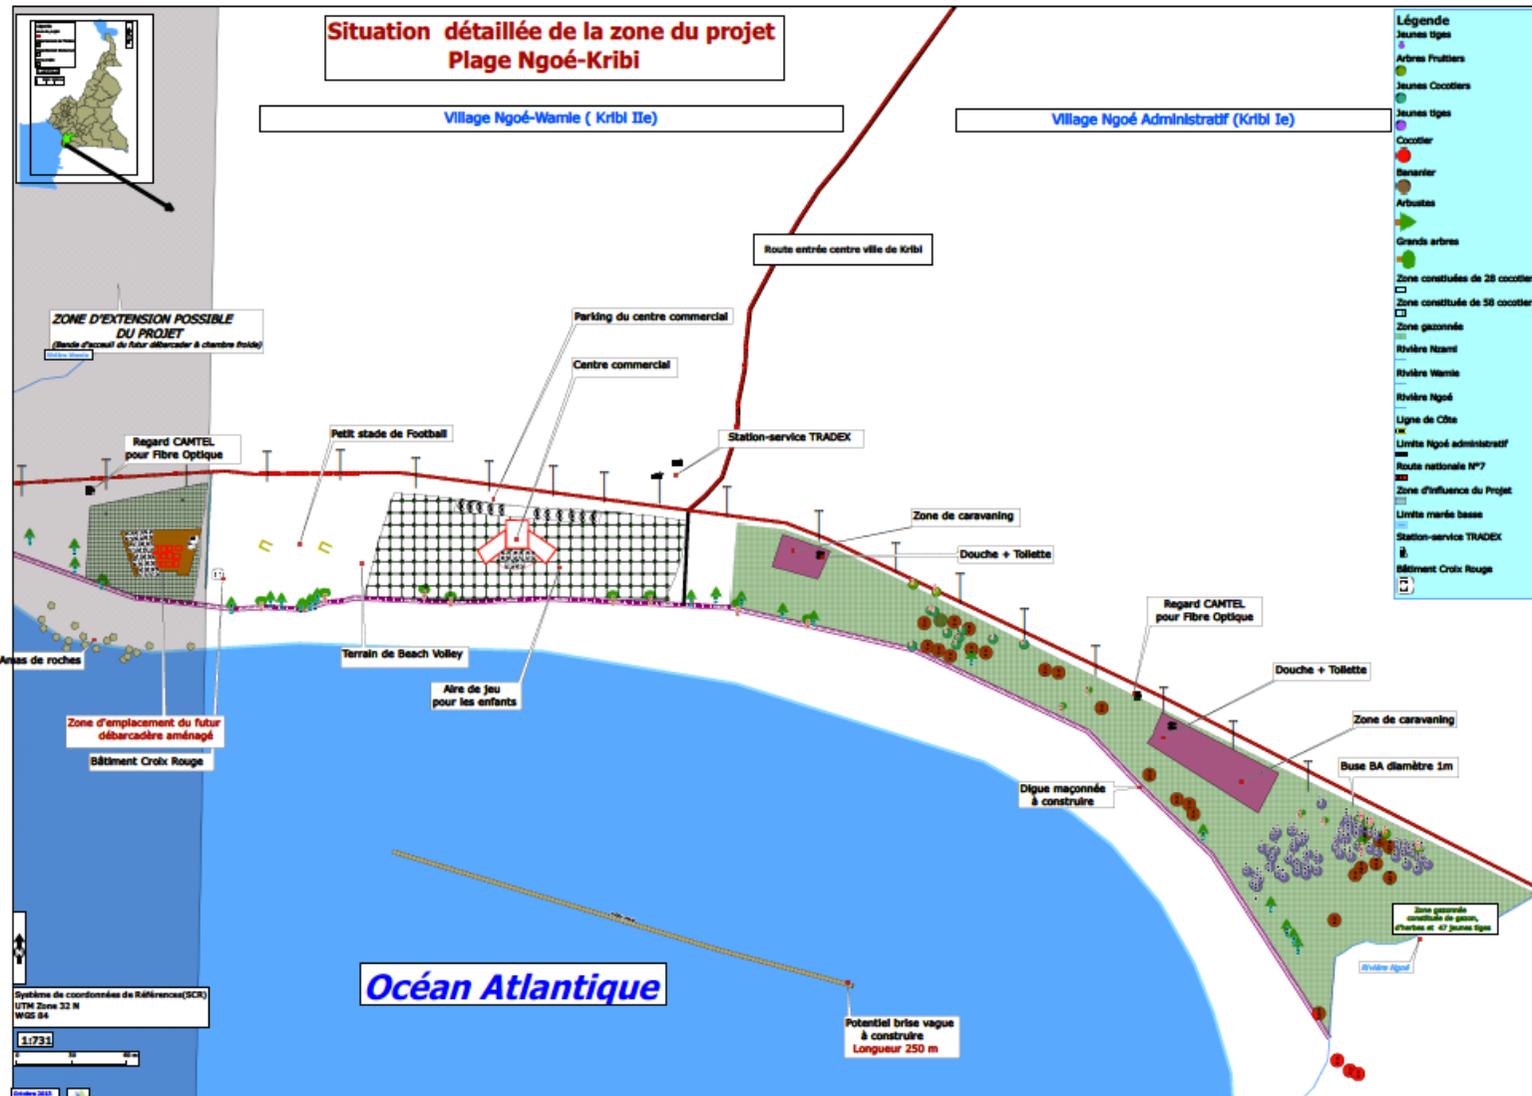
Carte du détail des aménagements proposés sur la section sud de la plage de Ngoye
